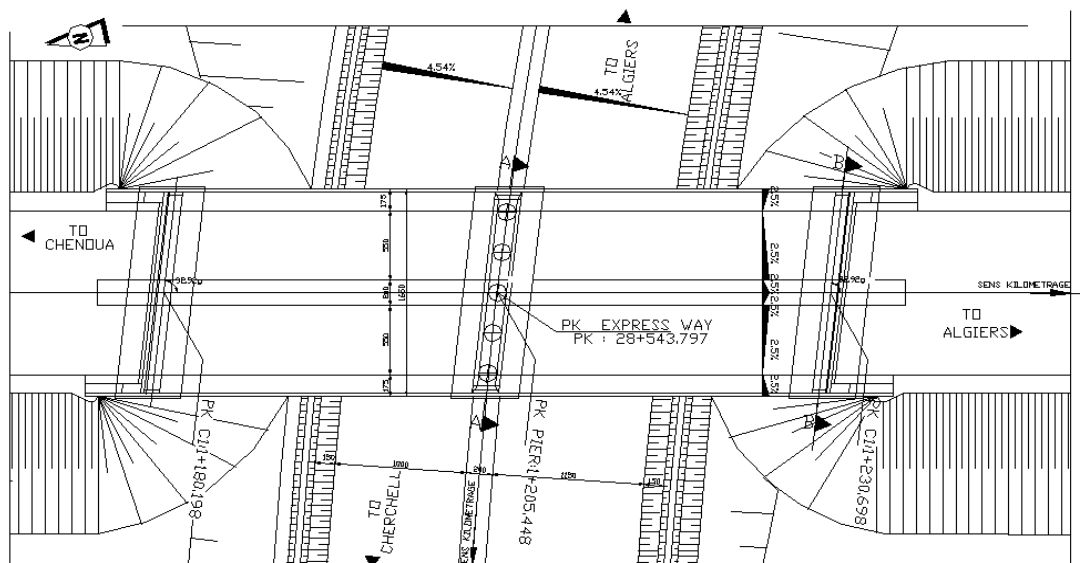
4 : Vue en plan de l'ouvrage au PK. 40+300.
